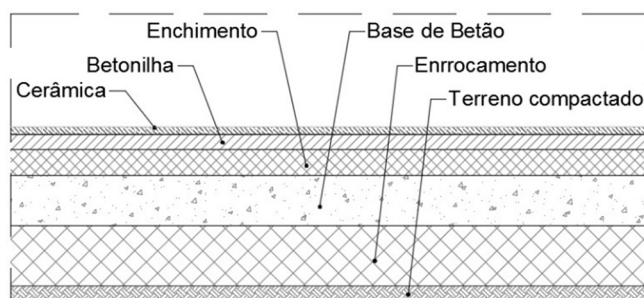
Pormenor de pavimento térreo (s/escala) – (Autor)
